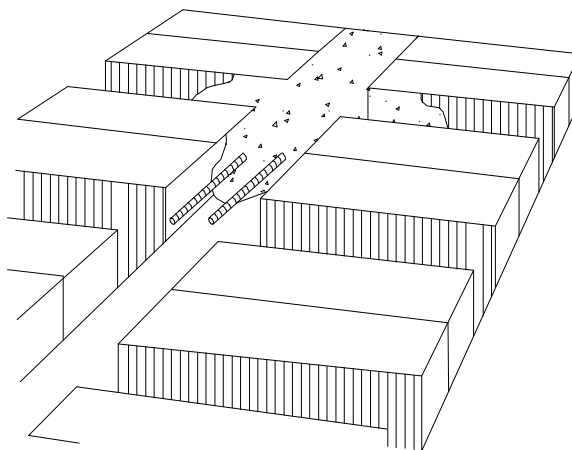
LOSA PLANA ALIGERADA CON BLOQUES DE CONCRETO.
